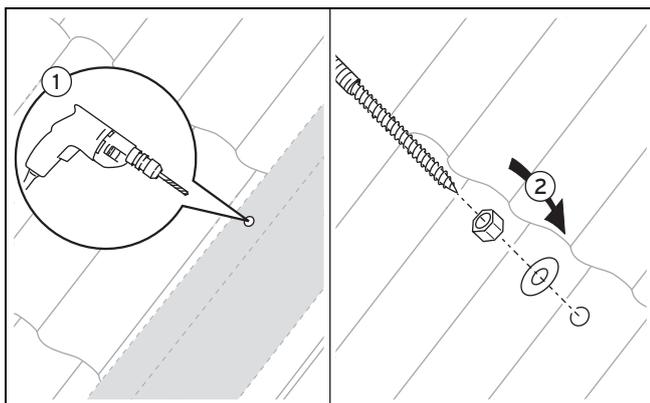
Position des Dachankers auf dem Dachsparren festlegen
